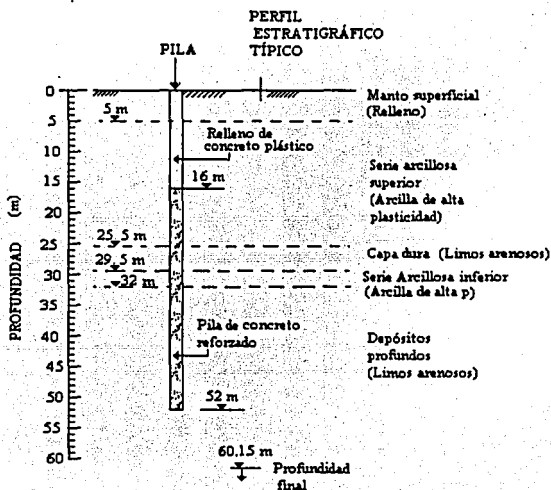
Estratigrafía y características de las pilas de cimentación.
